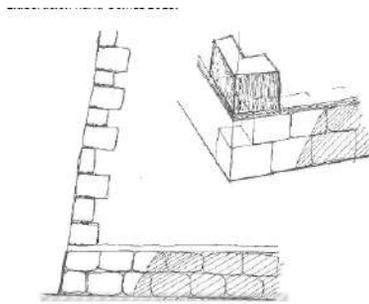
muro de sillares de piedra aparejada y sillares de esquina. Fachada norte fortificación militar Sisal Yucatán. Elaboración Karla Gómez 2018.
